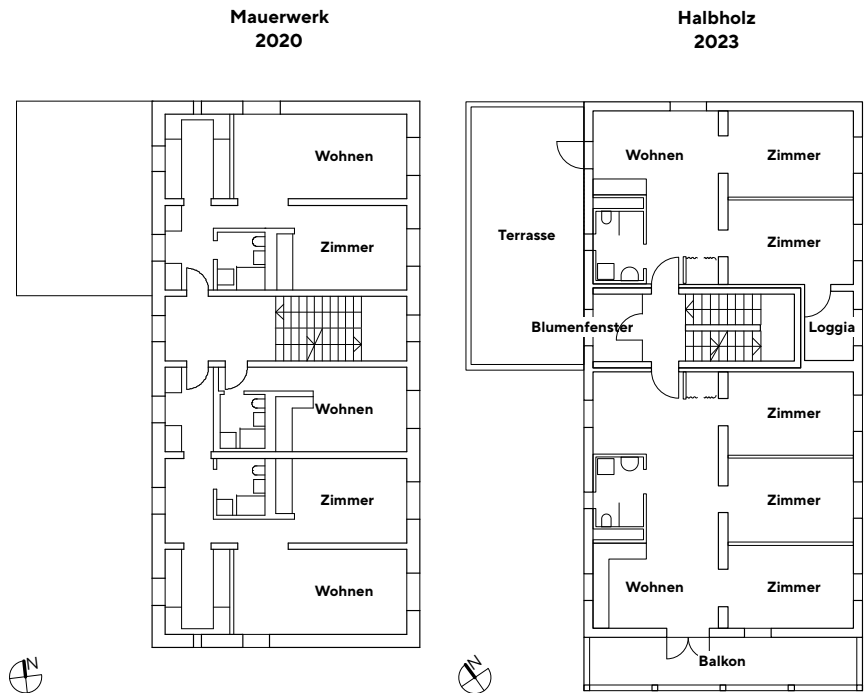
Gegenüberstellung der Grundrisse der Häuser Mauerwerk und Halbholz
